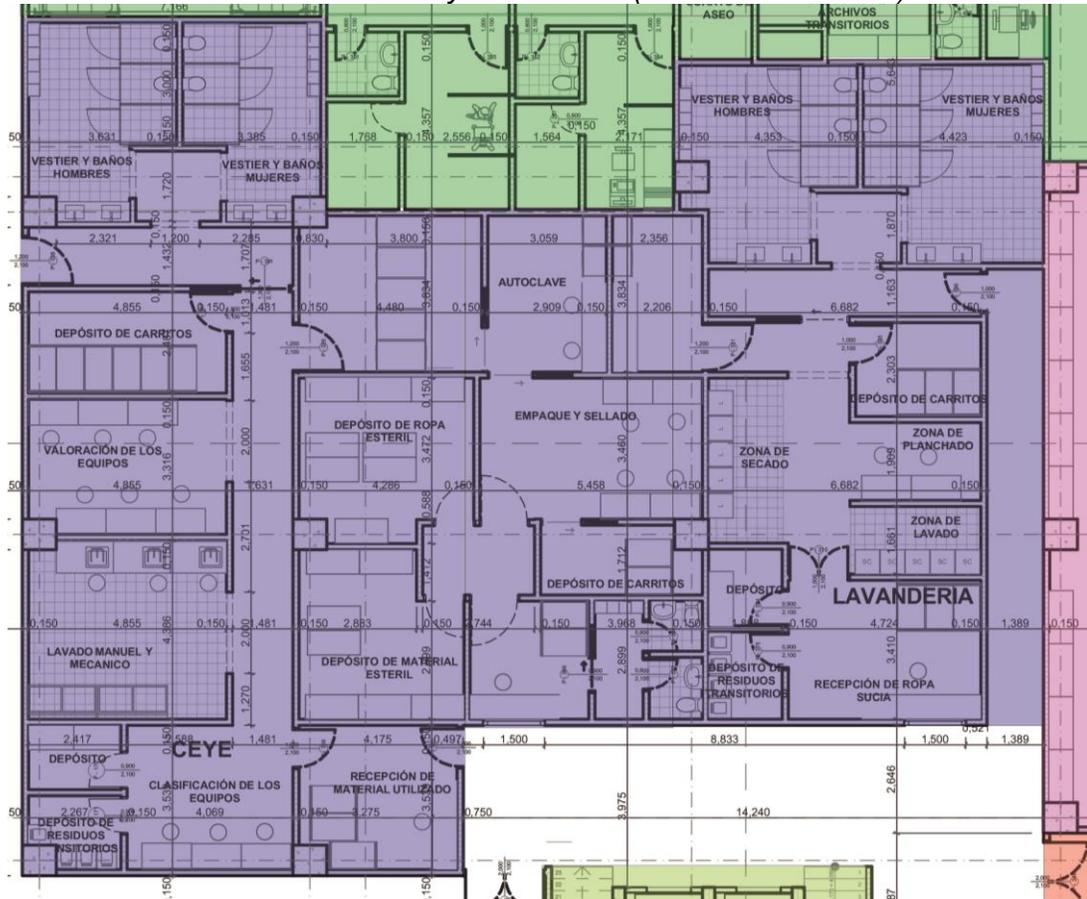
Zona de personal médico. (Plano Planta Piso 2)
